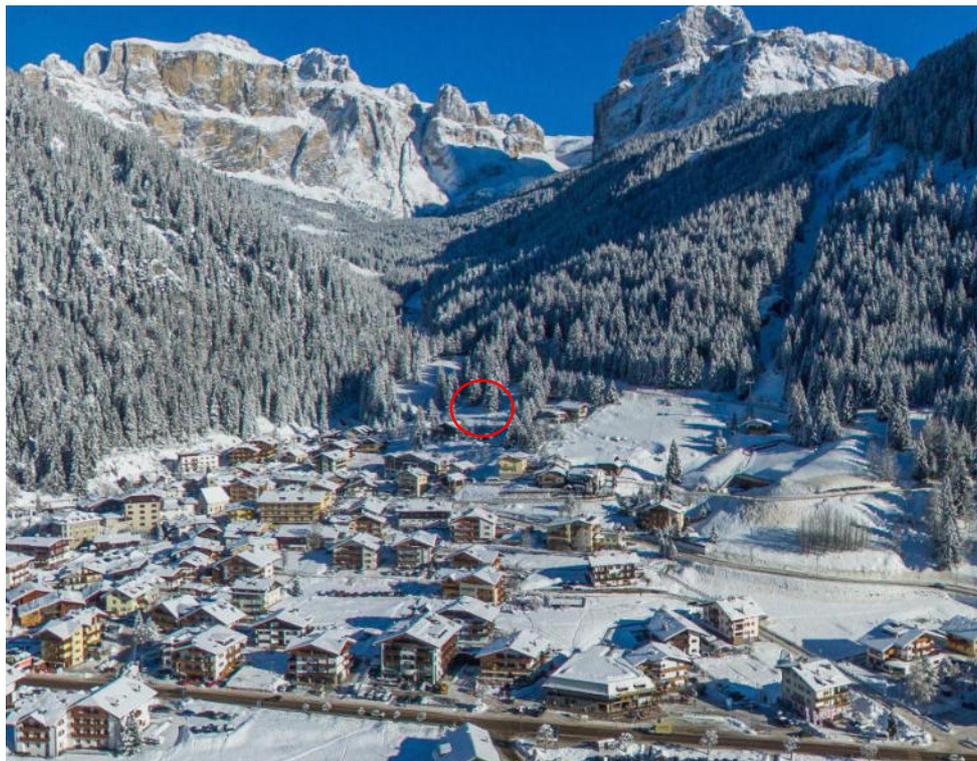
Vista dall'alto della posizione prevista per il nuovo edificio residenziale.
